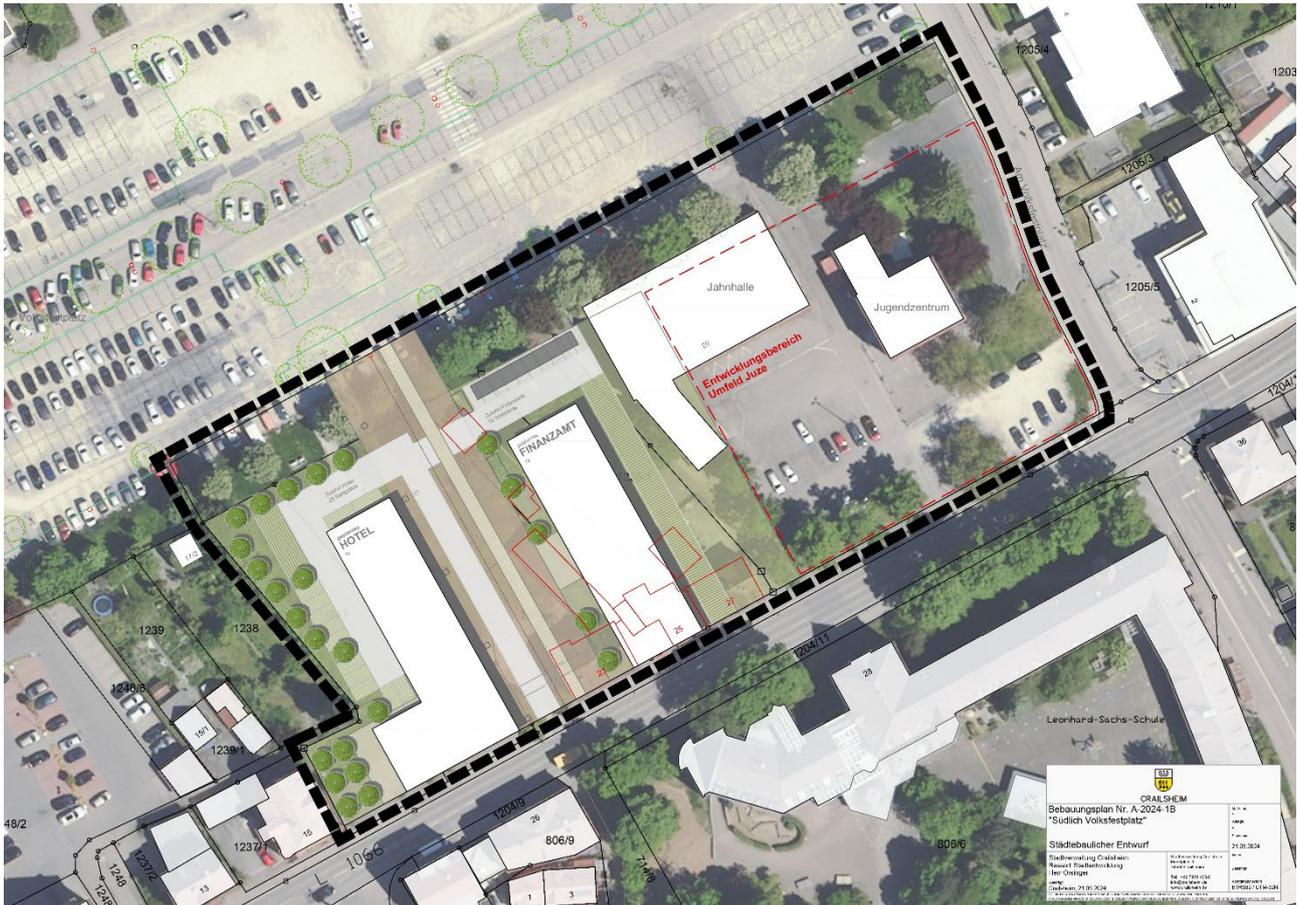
Städtebaulicher Entwurf mit Darstellung der aktuellen Planungen, Stand 21.03.2024
